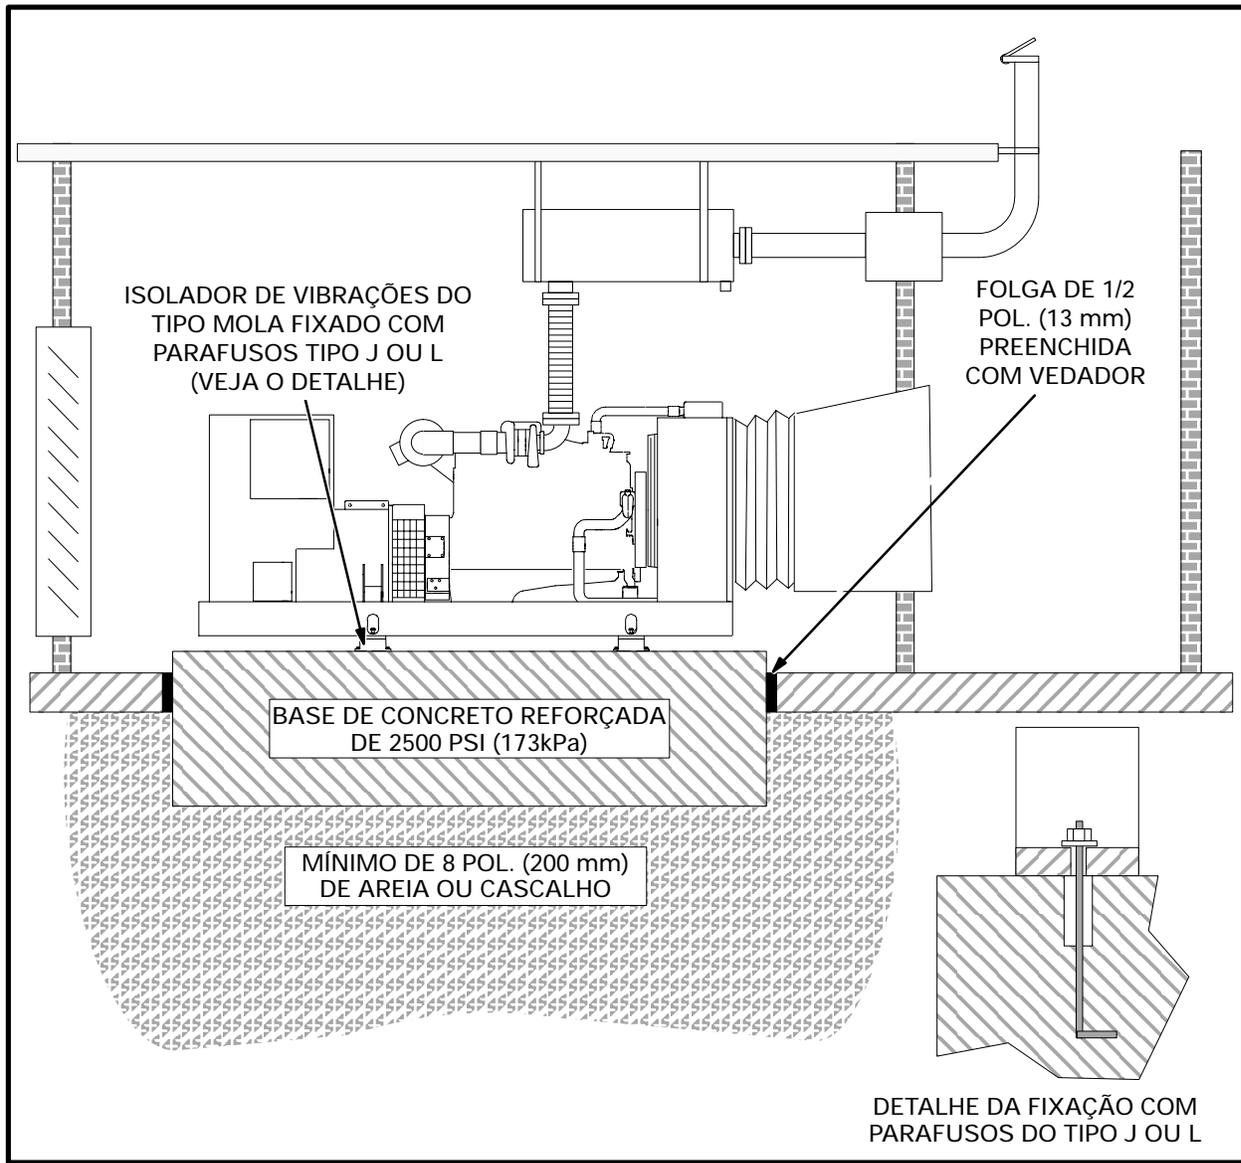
Fundação Típica de Isolamento de Vibrações
